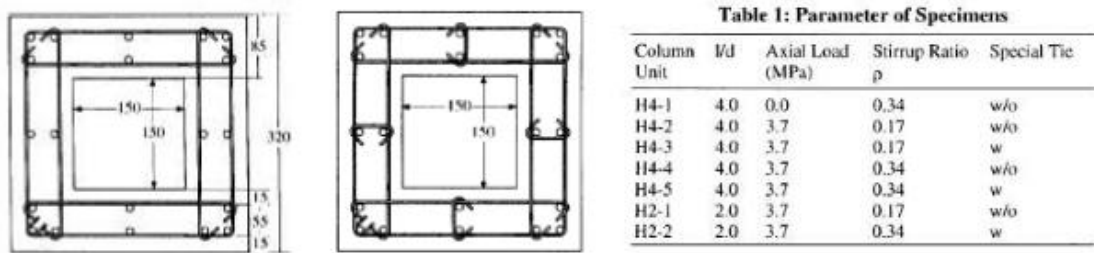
Pormenor das armaduras utilizadas por Takahashi
